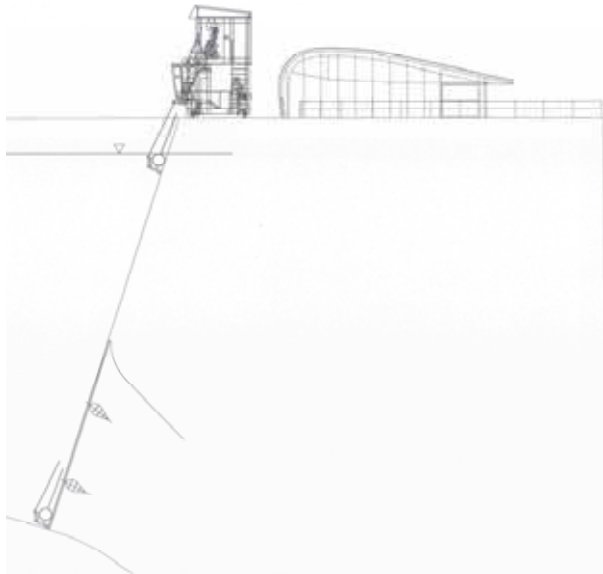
Seil-RRM, Putzlänge ca. 25 m
